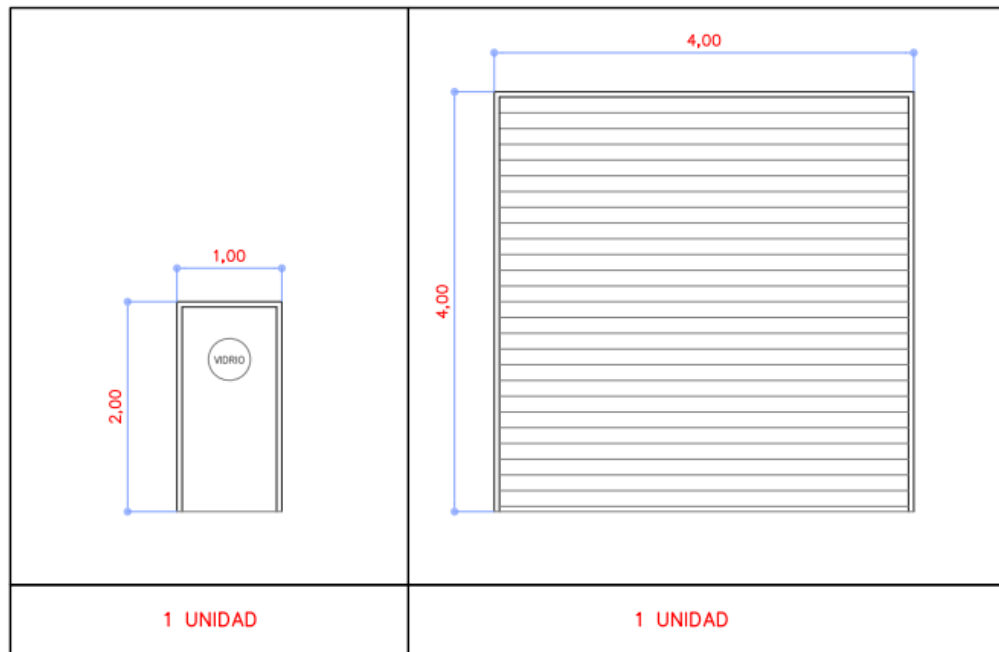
CARPINTERÍA METÁLICA - AUTOCAD
